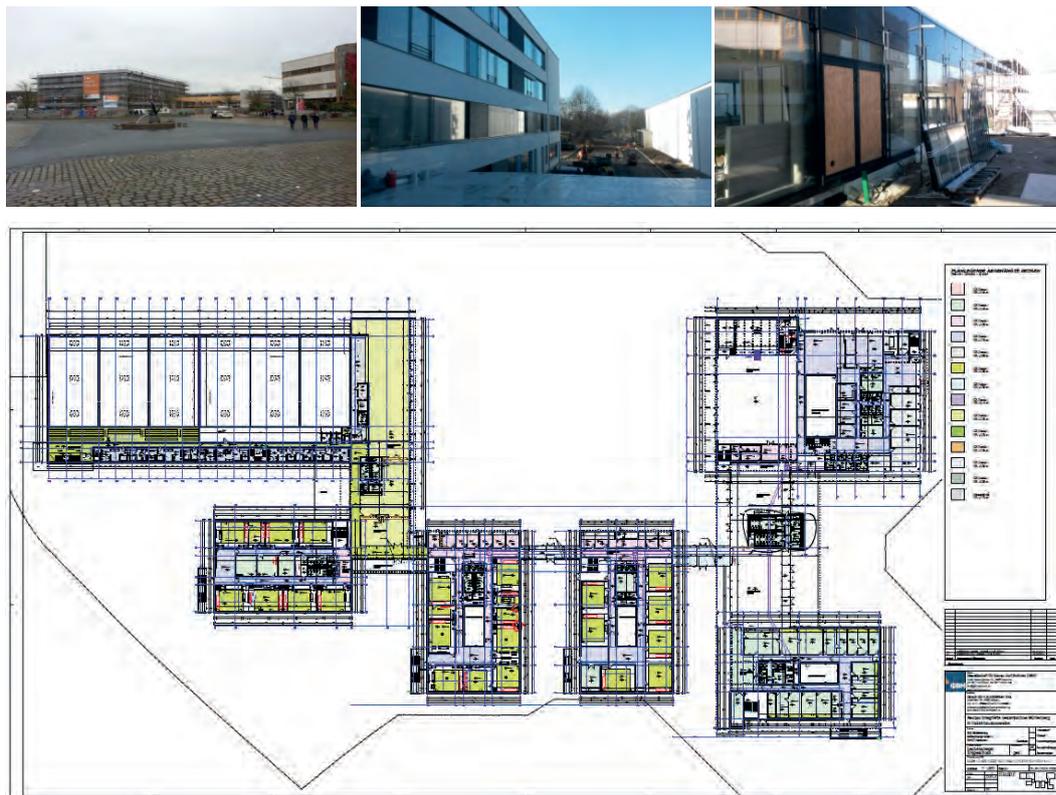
Grundriss des Erdgeschosses und Ansicht der Fassade der IGS Mühlenberg Gebäude A01
